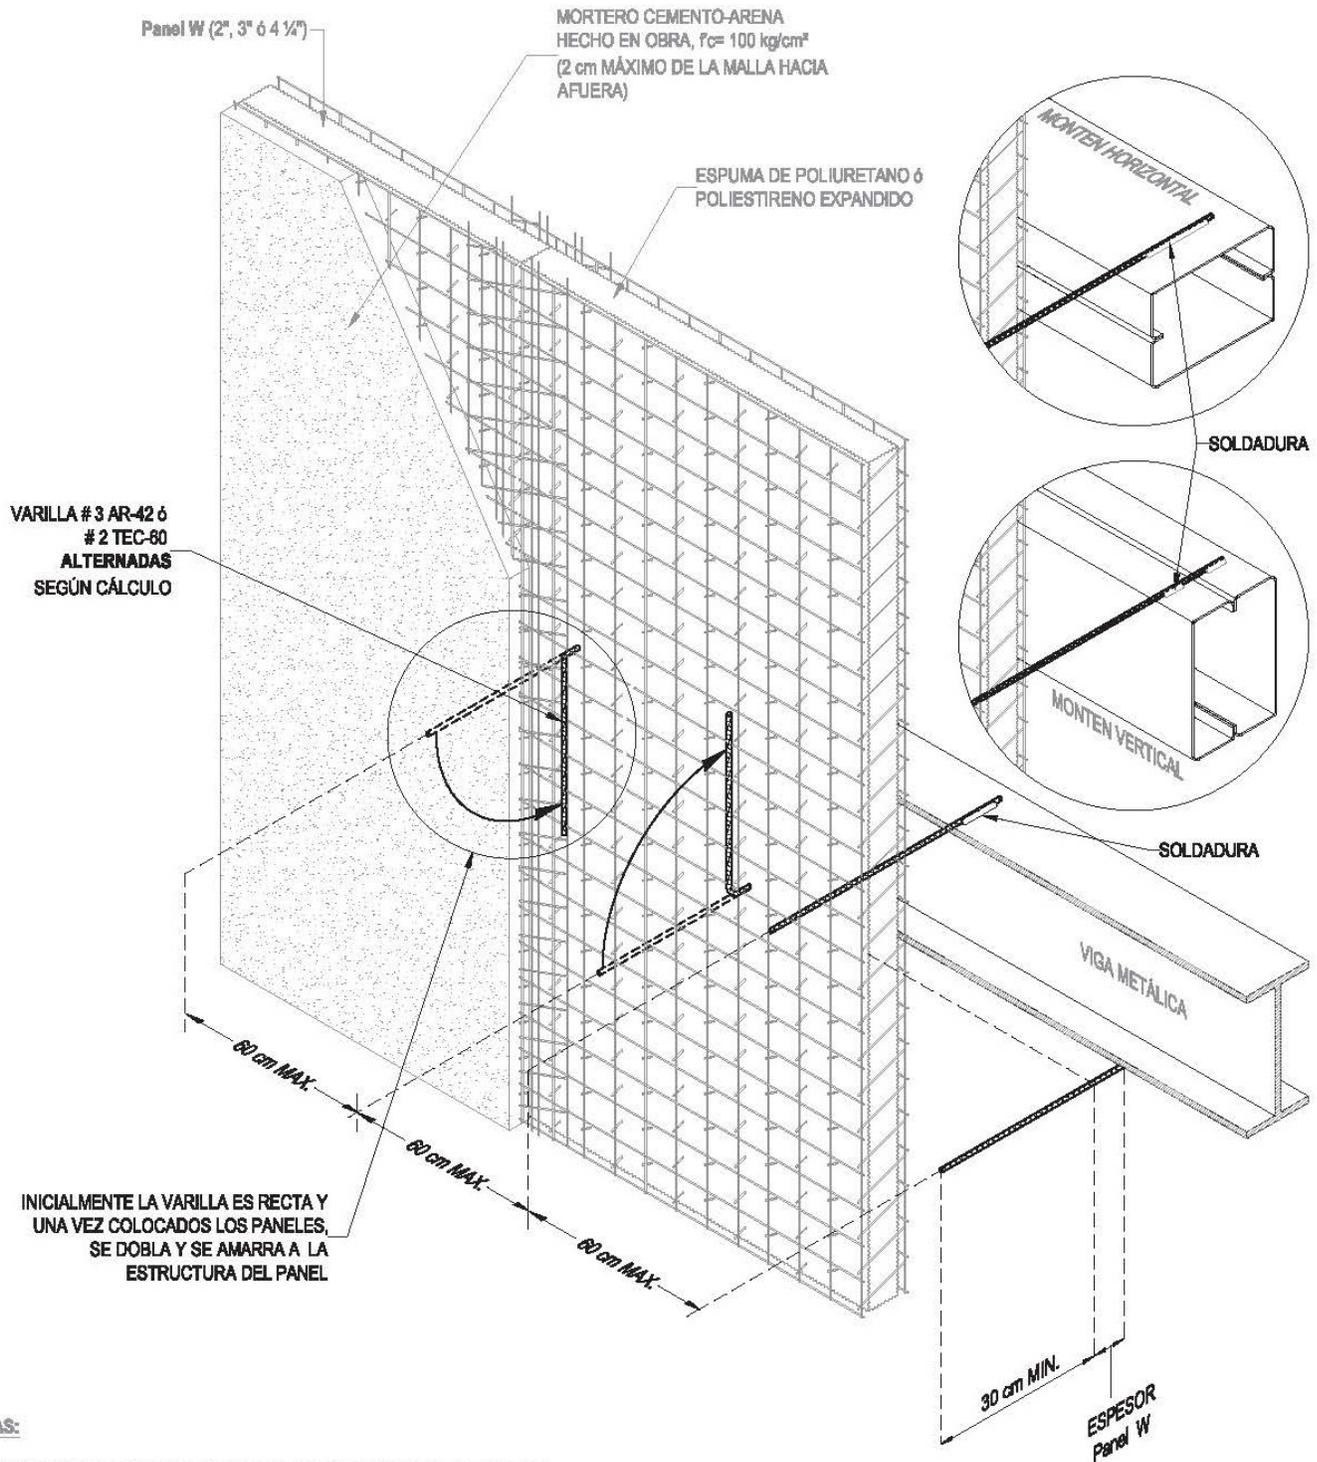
DETALLE DE MUROS EXTERIORES Y ACABADOS
